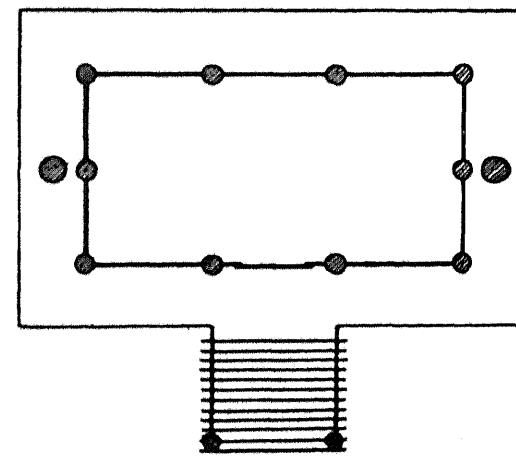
Ise-Daijingu, Grundriß (S. 17).
